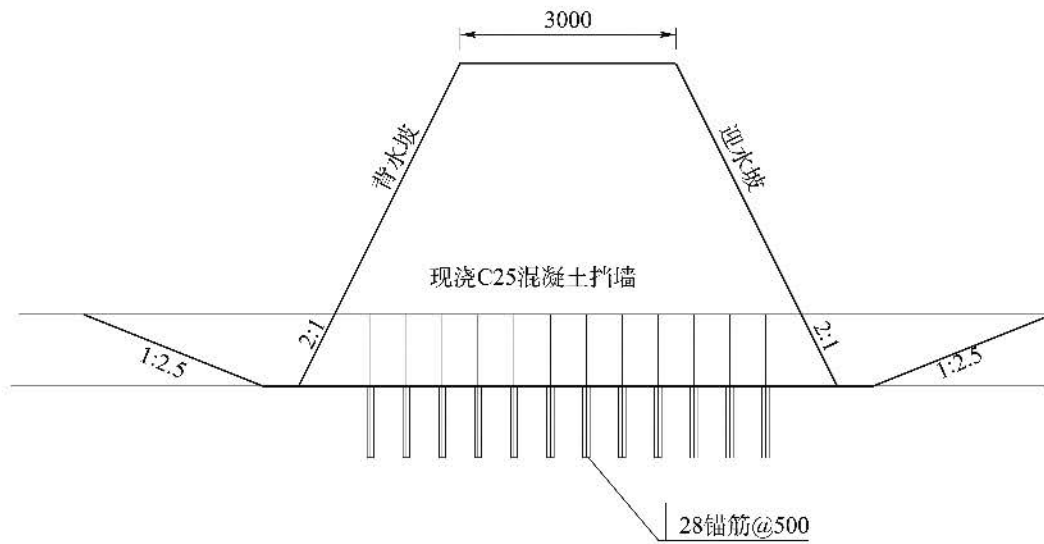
航道整治工程-闽江某航道整治工程-壅水坝和锁坝断面示意图(尺寸单位:mm;高程单位:m)
